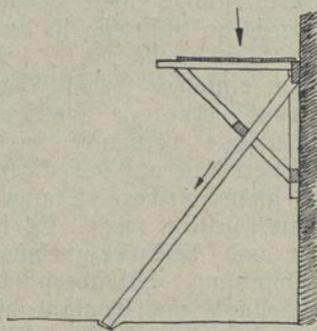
Englisches Puhgerüst, M. 1 : 50.
